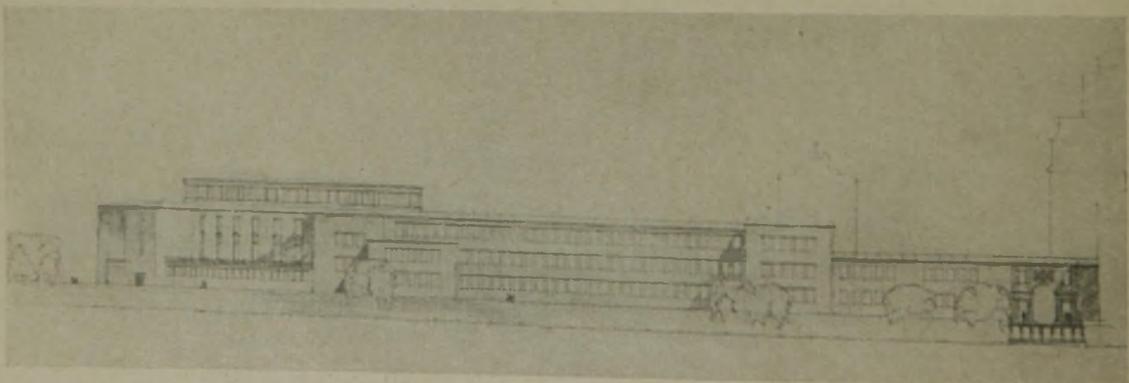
Ansicht der Westseite. (Vgl. Lageplan Abb. 7, S. 163, Grundriß Abb. 14, S. 164.)
